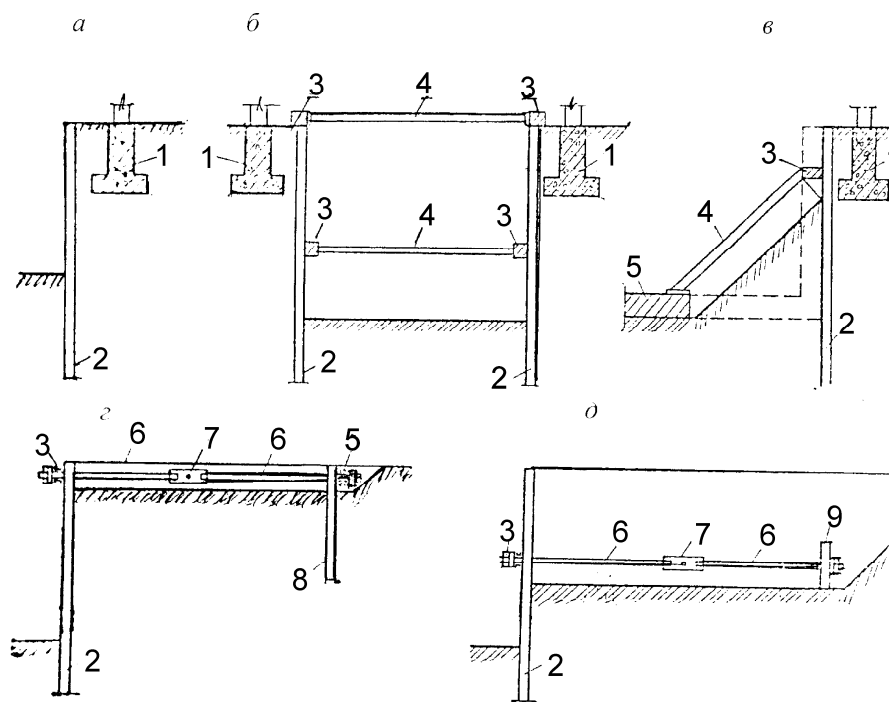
Крепление вертикальных стенок котлована в застроенной территории:
